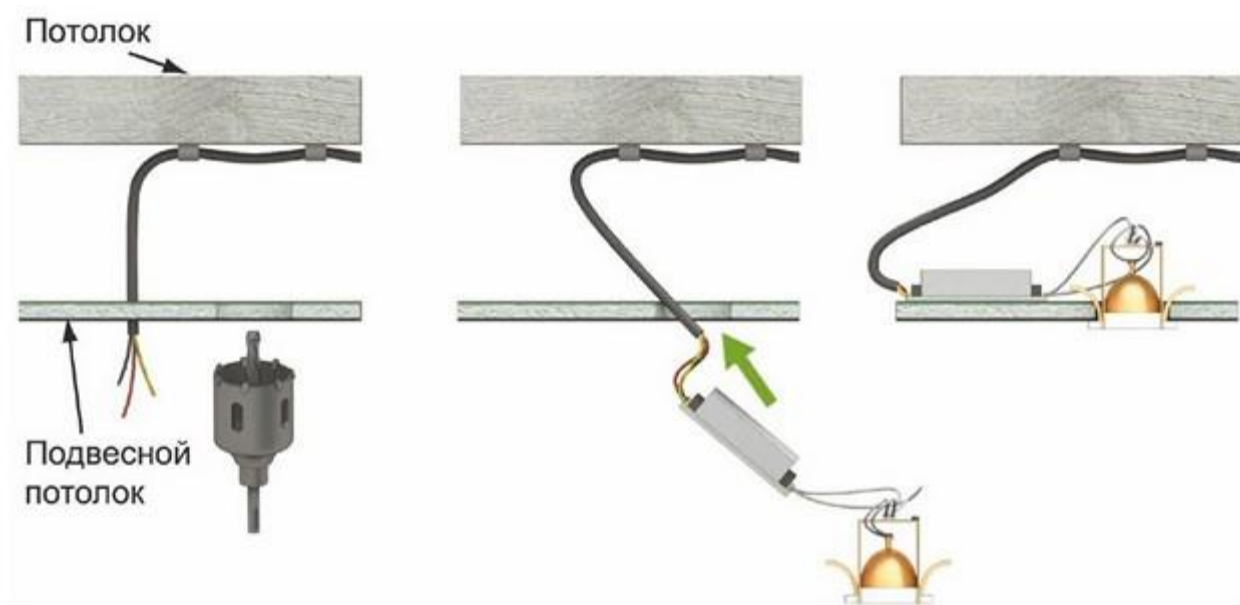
Прокладка кабеля на примере монтажа светильников
